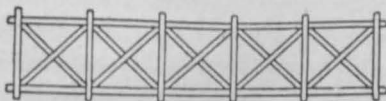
Parallelfachwerk mit Andreaskreuzen nach NAVIER.
